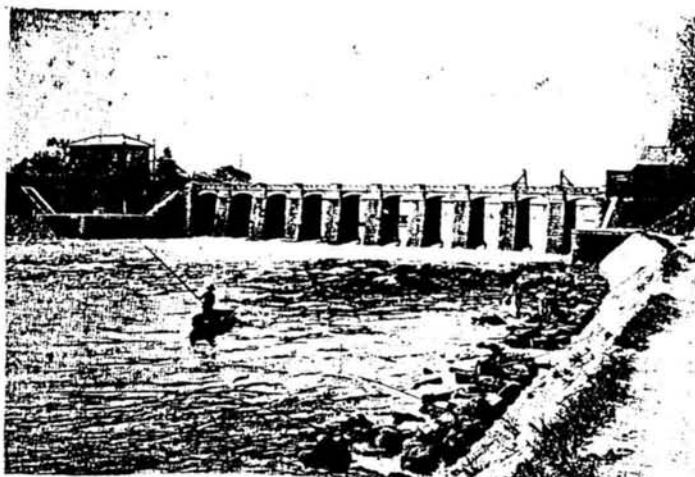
鴨川鉄筋コンクリート扶壁式
